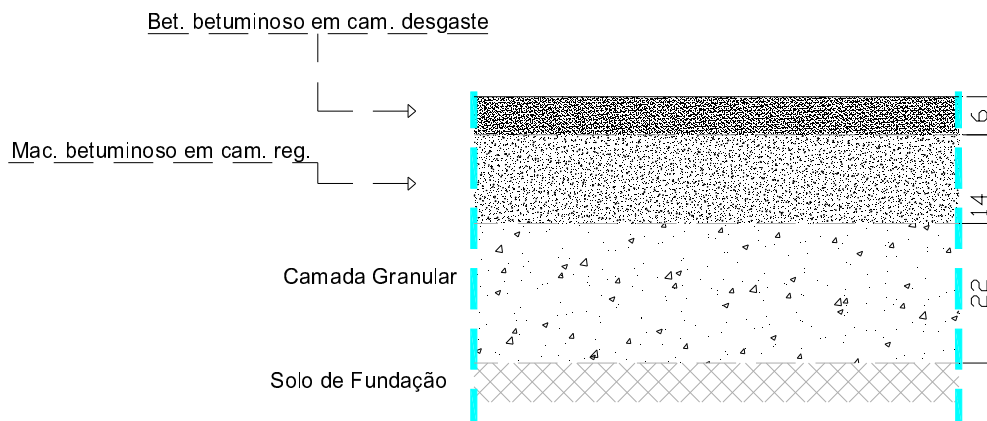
Estrutura do pavimento da Rua Cónego Dr. Manuel Faria para a alternativa de fresagem e reposição
